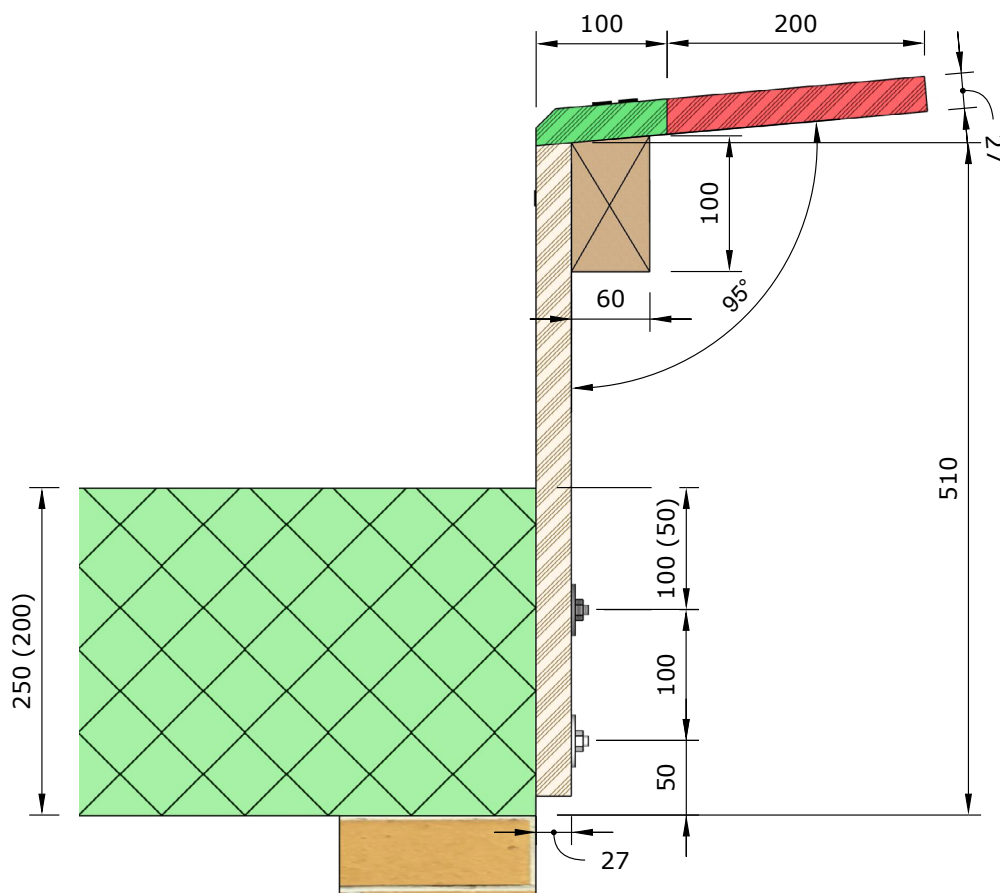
Schnitt durch Dachrandkonstruktion beschränkt betretbar, Masse in mm.
